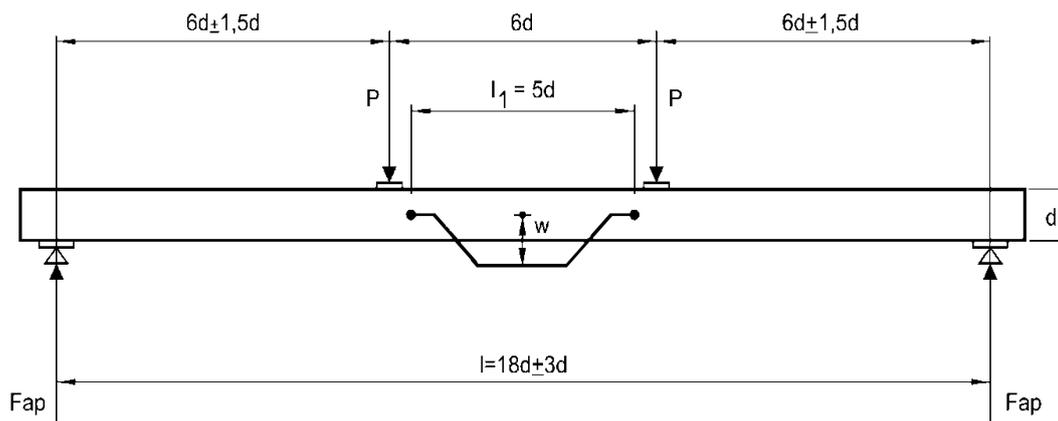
Esquema de aplicación de carga en vigas laminadas.
